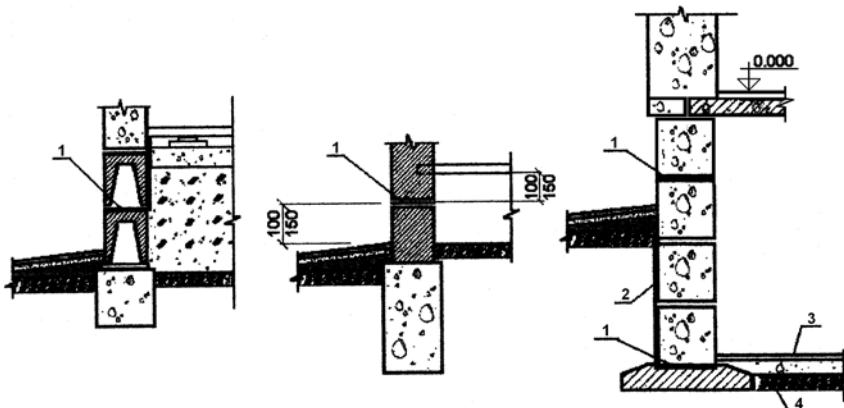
Гидроизоляция фундаментов от капилярной влаги.
